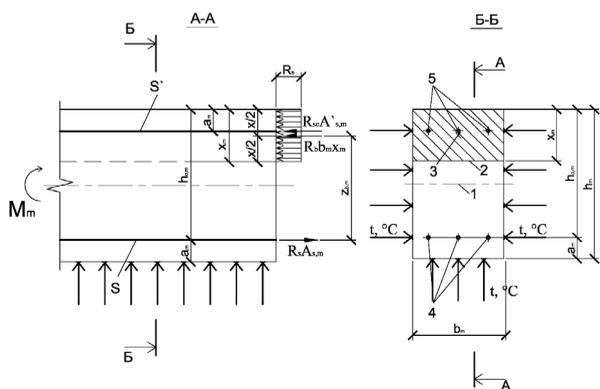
Схема расчета на огнестойкость масштабной модели железобетонной балки прямоугольного сечения с двойной арматурой
